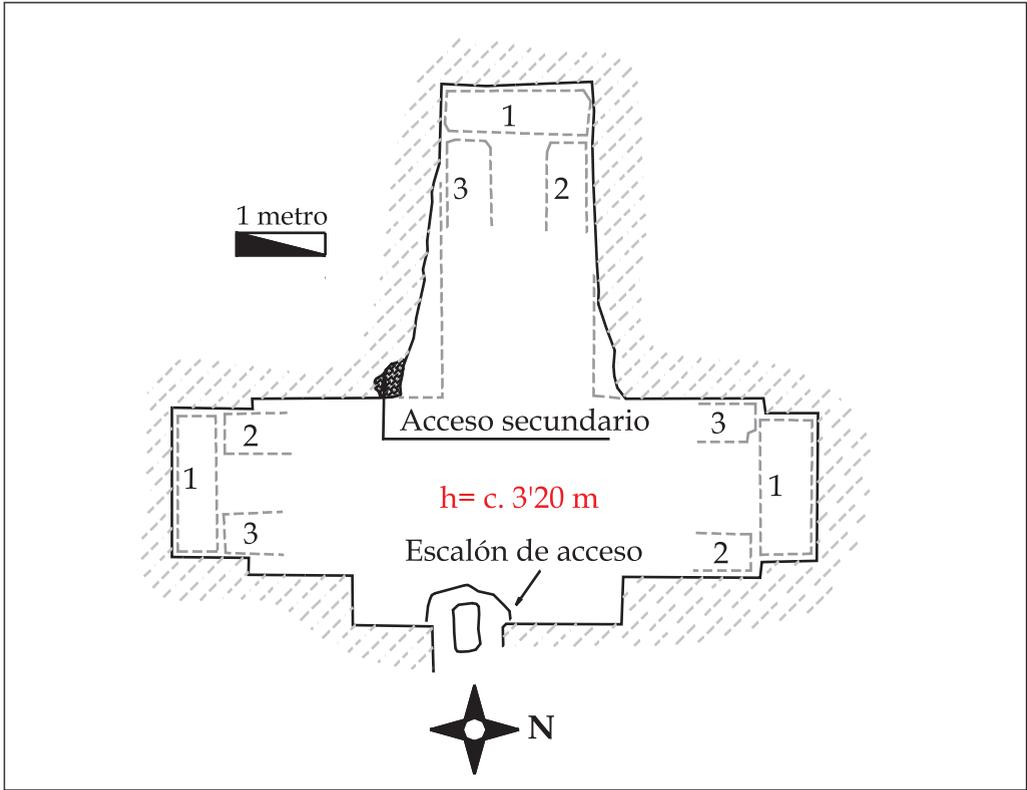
Planta del hipogeo QM C2/13. Tipo 3
